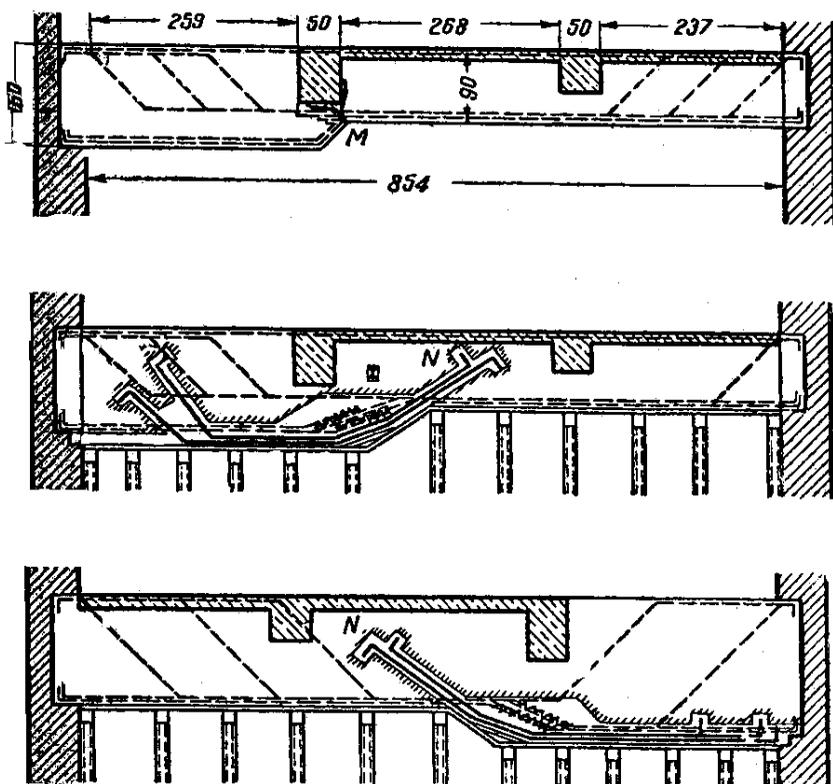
Усиление железобетонной балки путем частичного увеличения ее сечения с установкой дополнительной арматуры: *M* – трещины в балке; *N* – сквозные пробоины для установки дополнительной арматуры
